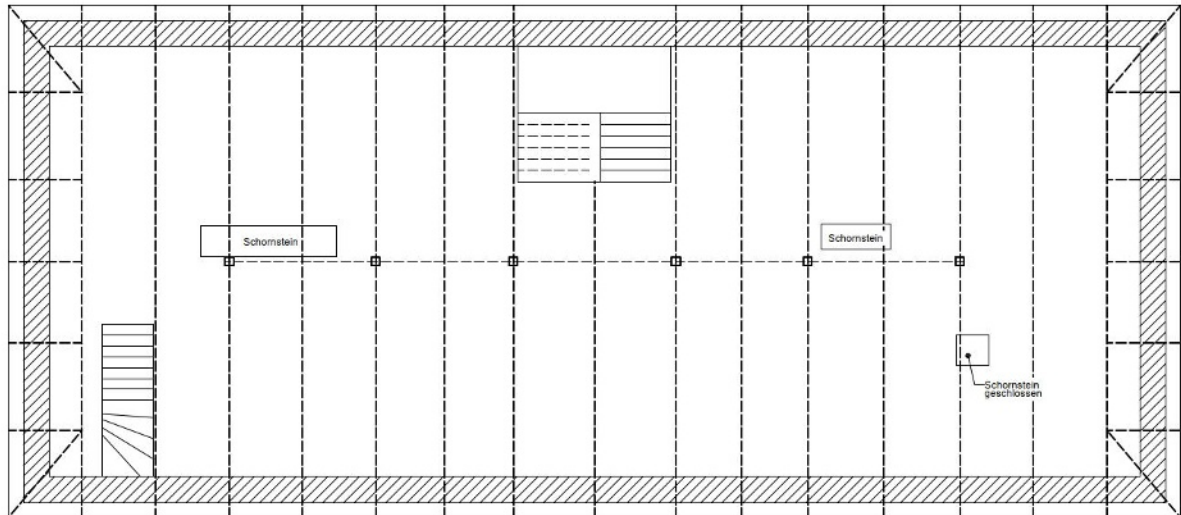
Skizze vermutete Zugbalkenlage Dachkonstruktion
